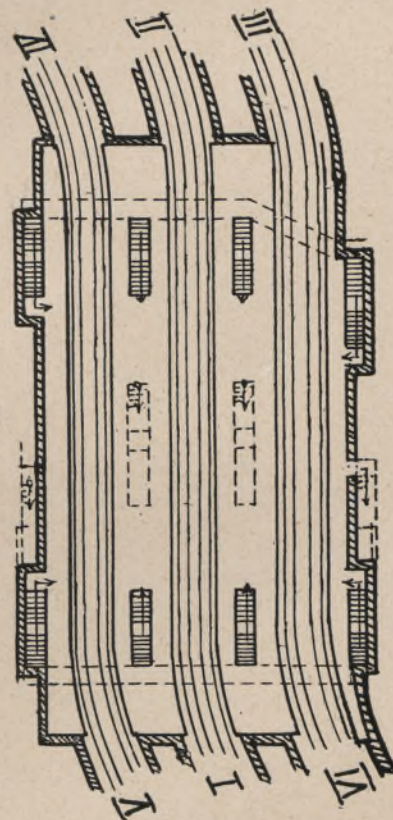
Grundriß des Untergrundbahnhofs bei A.
